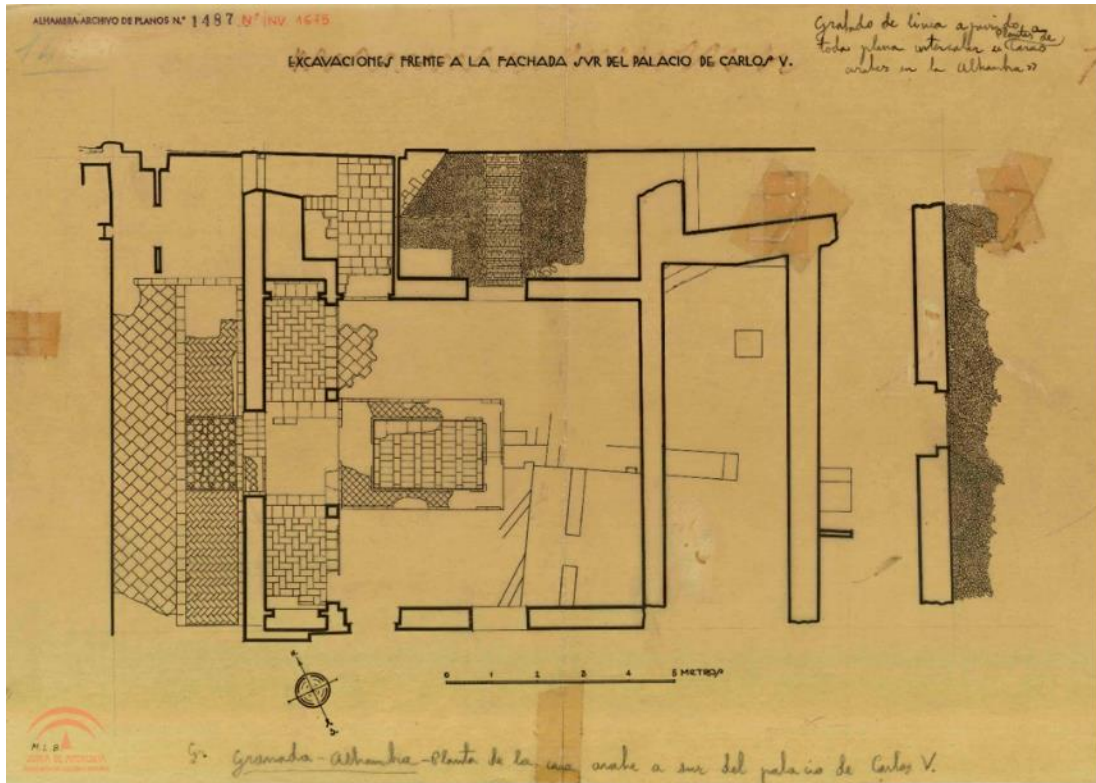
Plano de las excavaciones en la casa al sur del Palacio de Carlos V
